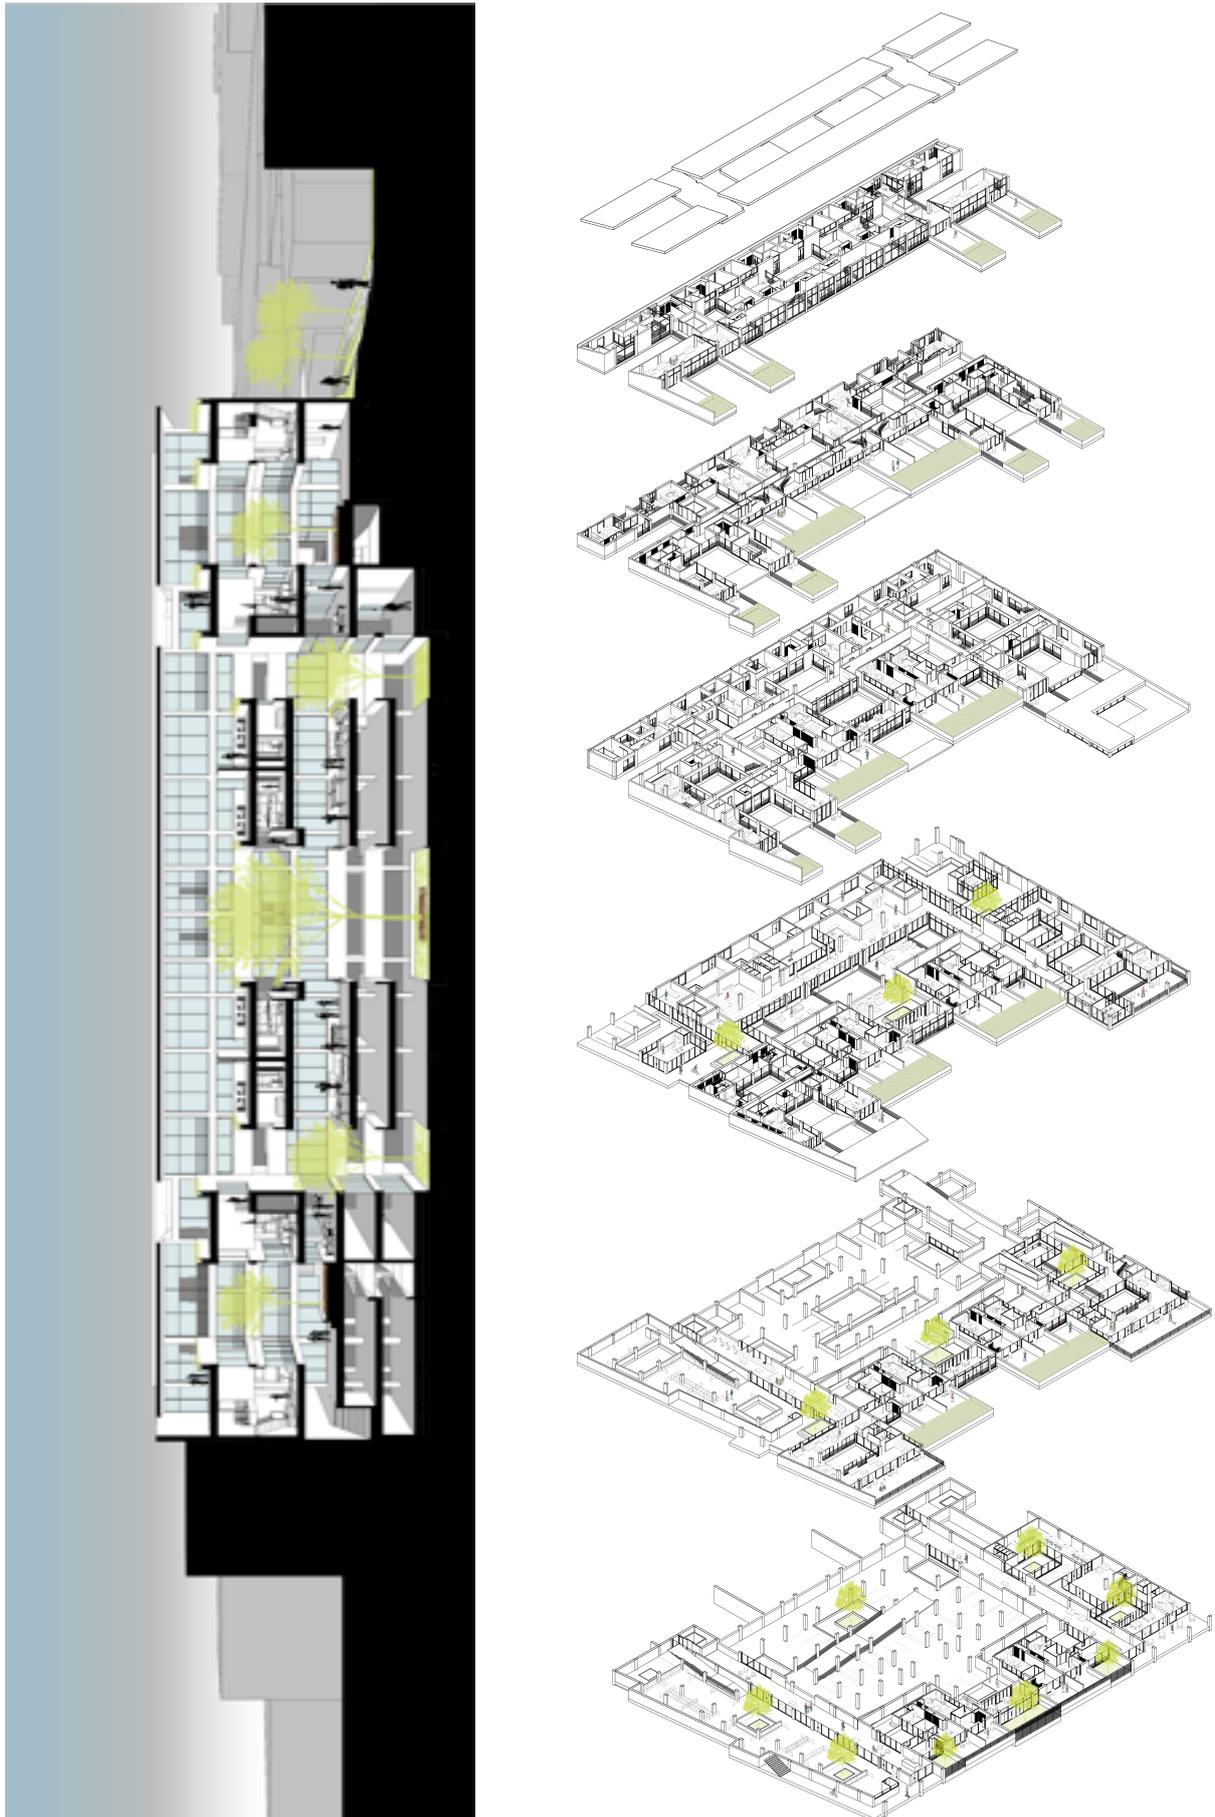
Corte Fugado Y Axonometría Explotada(Elab. Propia)
